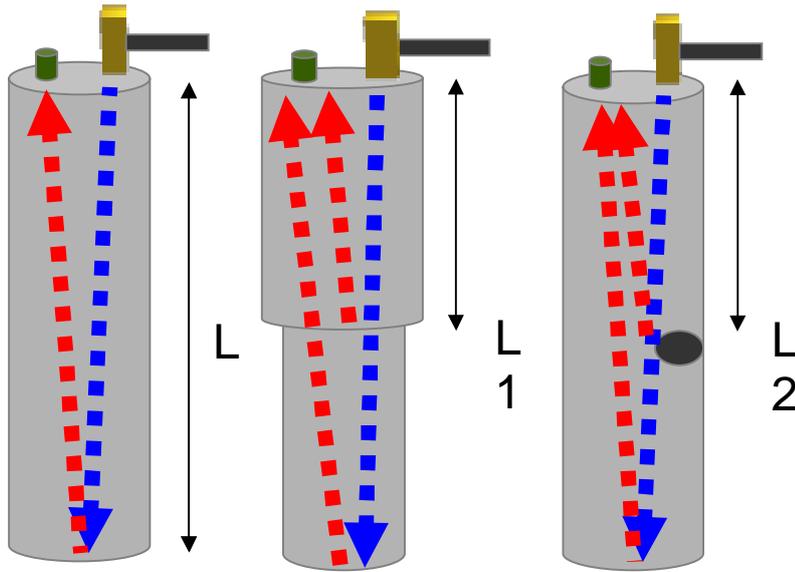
Riflessione del piede del palo, riflessione dovuta alla riduzione della sezione, riflessione dovuta a difetto interno.
